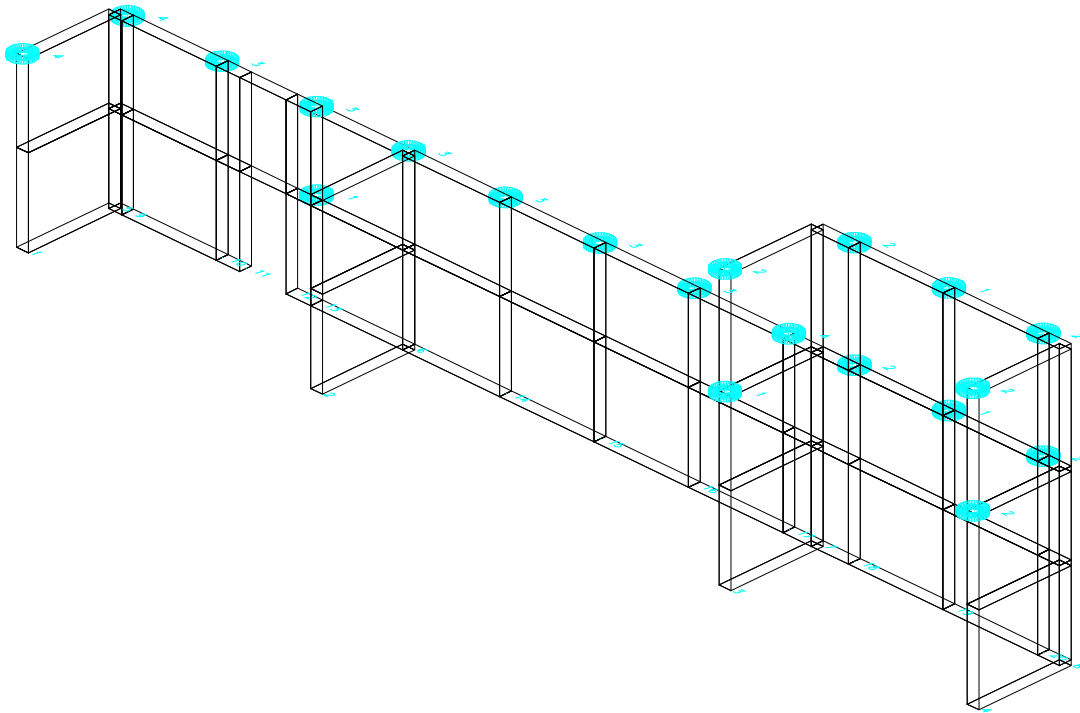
Vista prospettica della struttura vista dal lato edificio.
